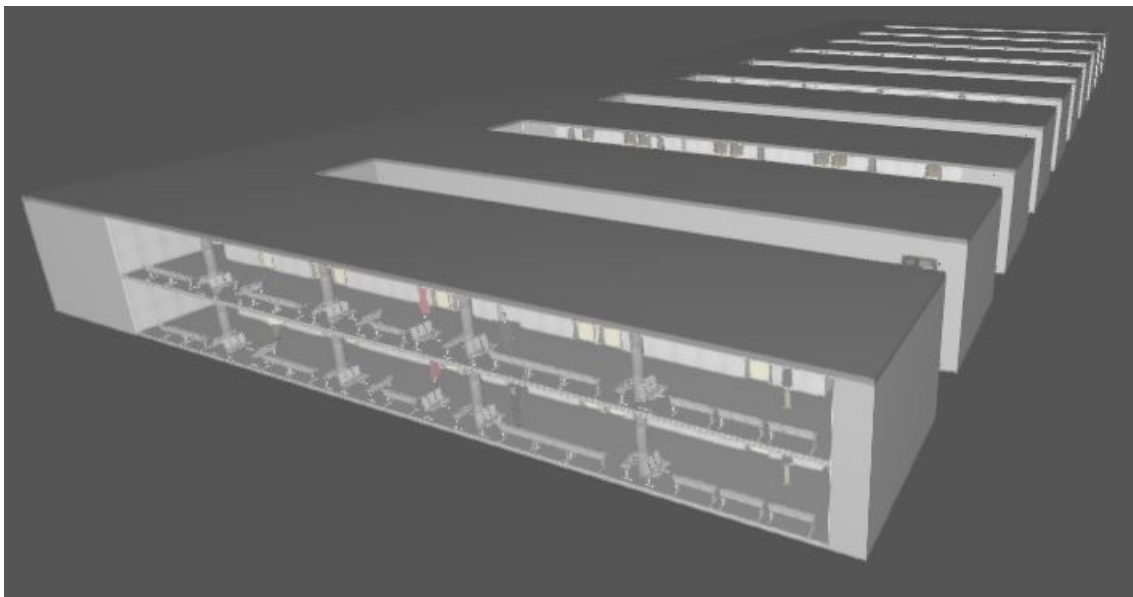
Modelo 3D completo, planta 2° y 3° (1). *Fuente: Elaboración propia
